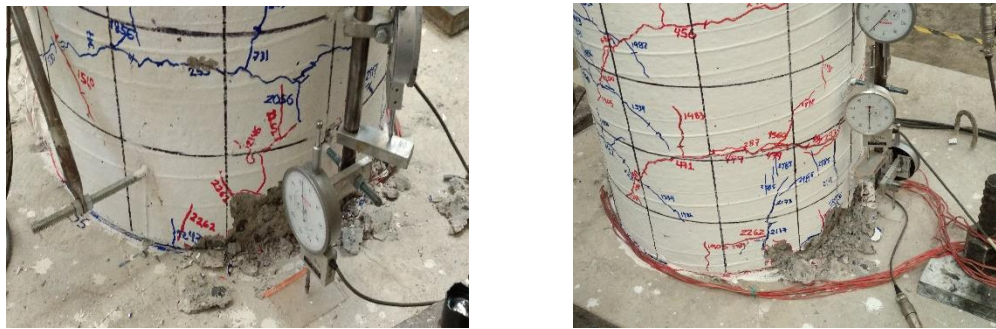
Primeras grietas de cortante de espécimen MC-2
